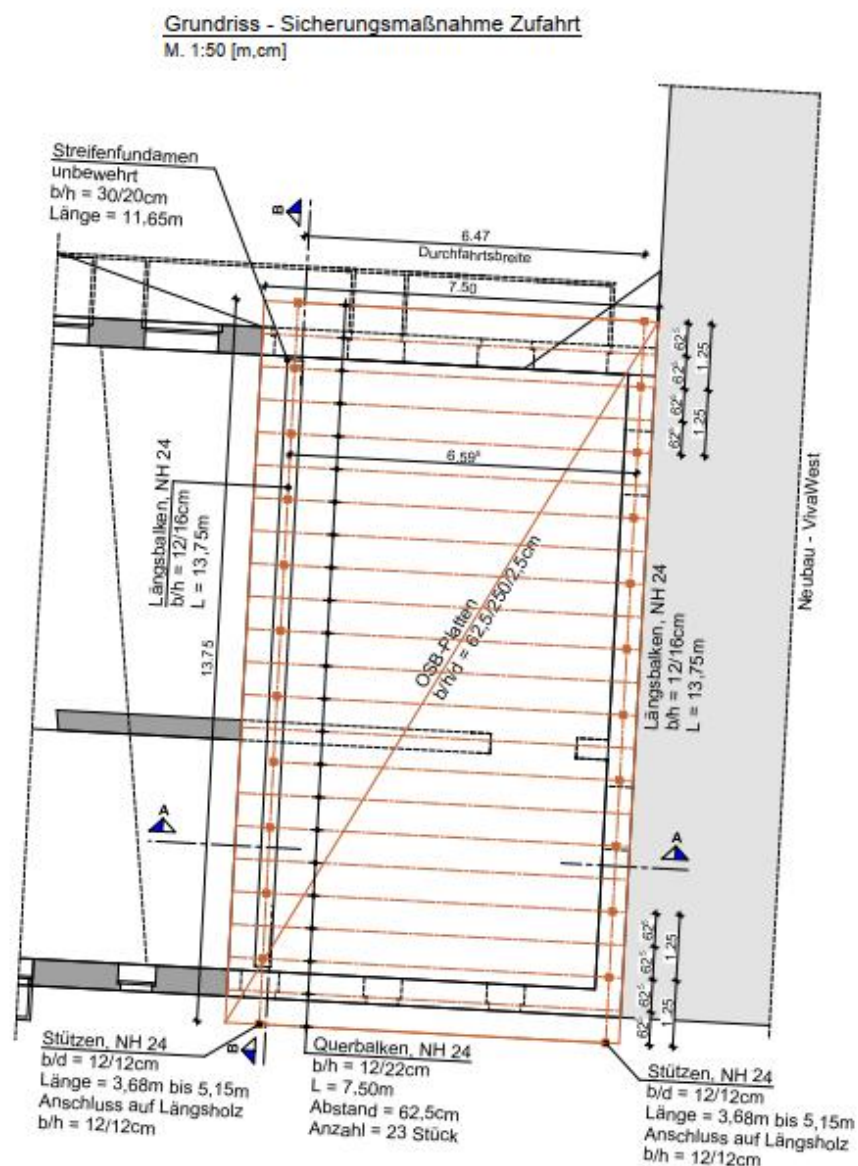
Grundriss Sicherungsmaßnahme Zufahrt (Auszug Plan RP-104)
